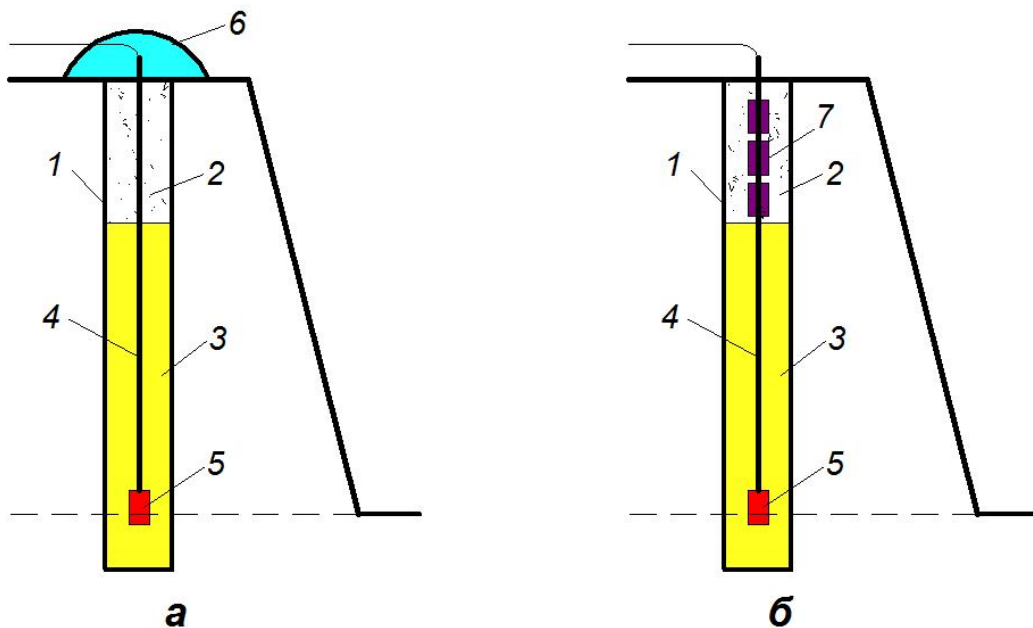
Конструкція забійки свердловинного заряду: а) з пакетом з водою; б) із запірними зарядами ВР; 1 – свердловина; 2 – набійка; 3 – ВР; 4 – ДШ; 5 – бойовик; 6 – пакет з водою; 7 – тротиліві шашки
